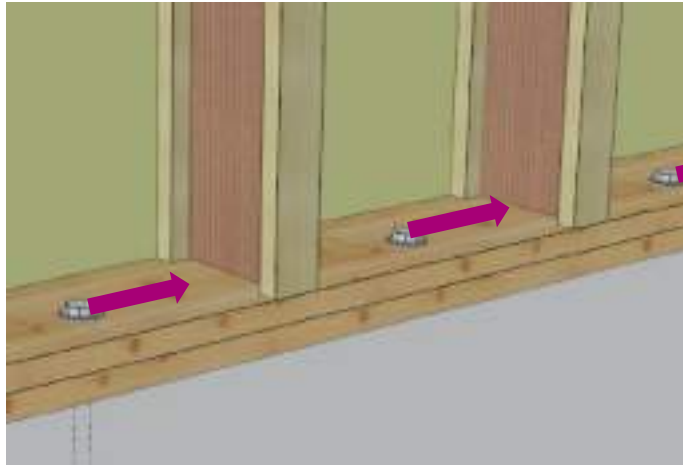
Ancrages en pied de mur pour transférer l'effort de contreventement à l'ouvrage sous-jacent
